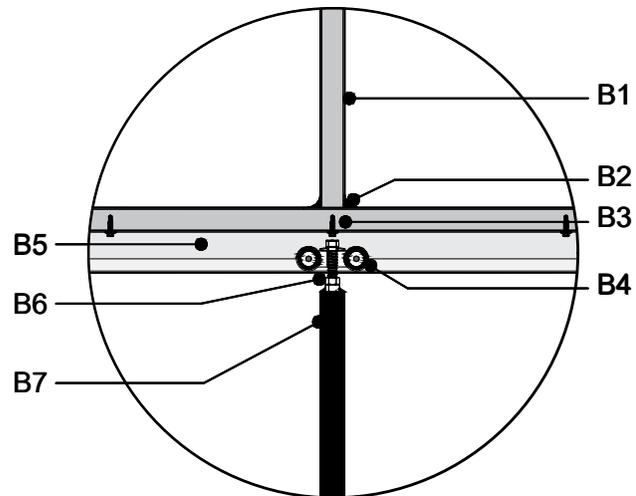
Detalle Constructivo 2 – Riel de Aluminio para estructura
